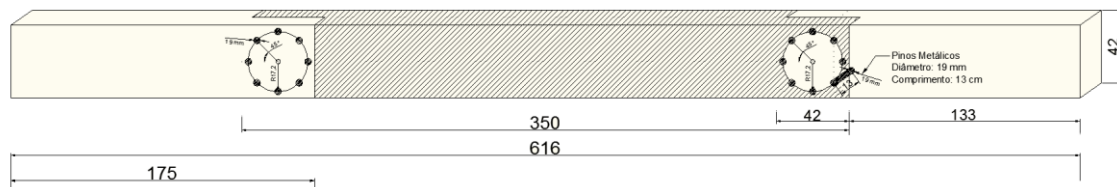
Visão geral do layout para preparação da emenda e ligações. Dimensões em centímetros.
